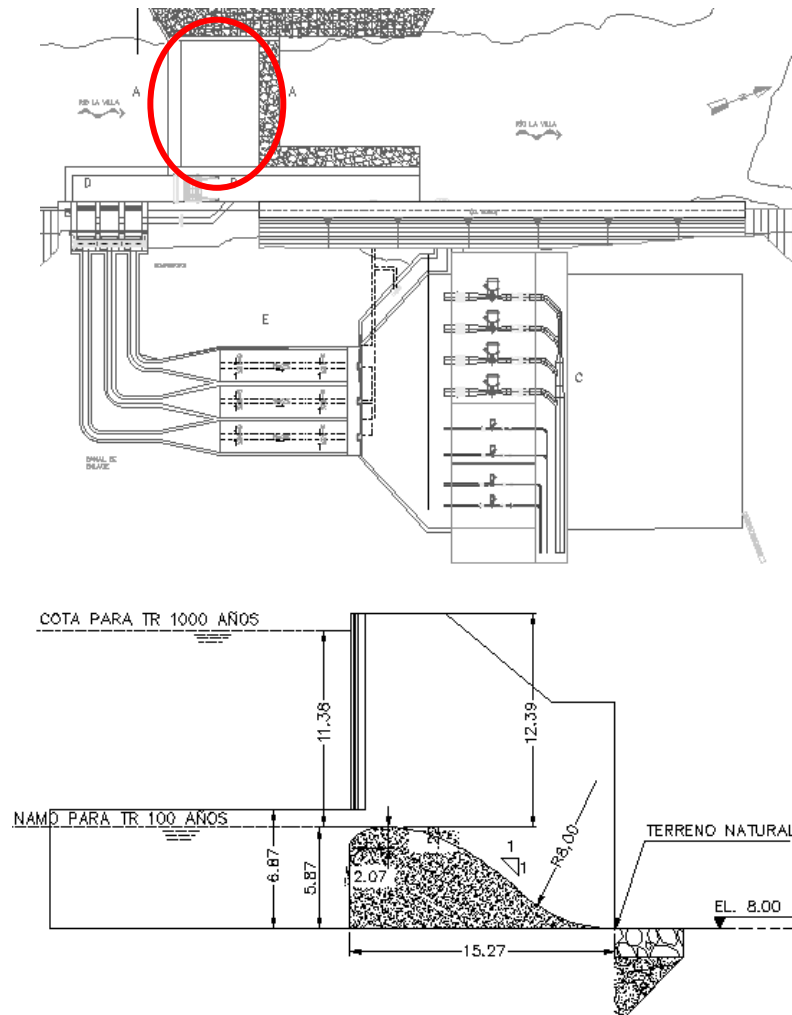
Localización en planta y Corte Transversal Vertedero El Gato
